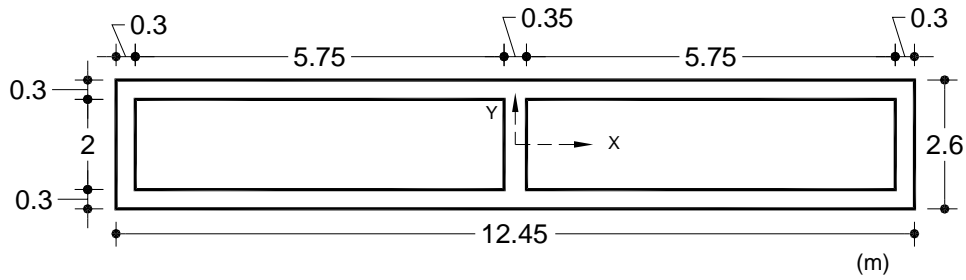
Sección 3 de la columna 2. (No. 5)
